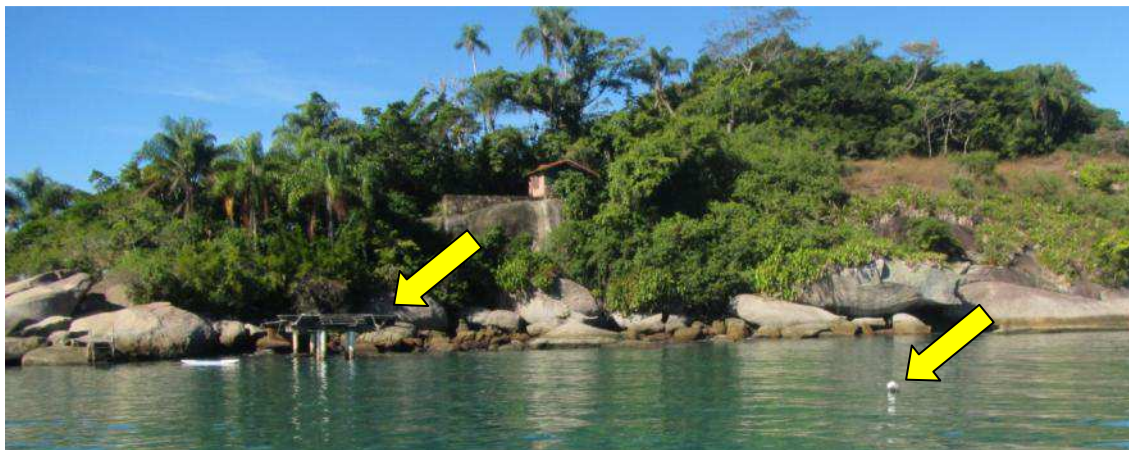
Cais de acesso medindo aproximadamente 20 m x 5 metros, construído em madeira, apoiado sobre pilotis e muro de pedras sobre o costão rochoso, e boia de fundeio, ambos indicados pelas setas
